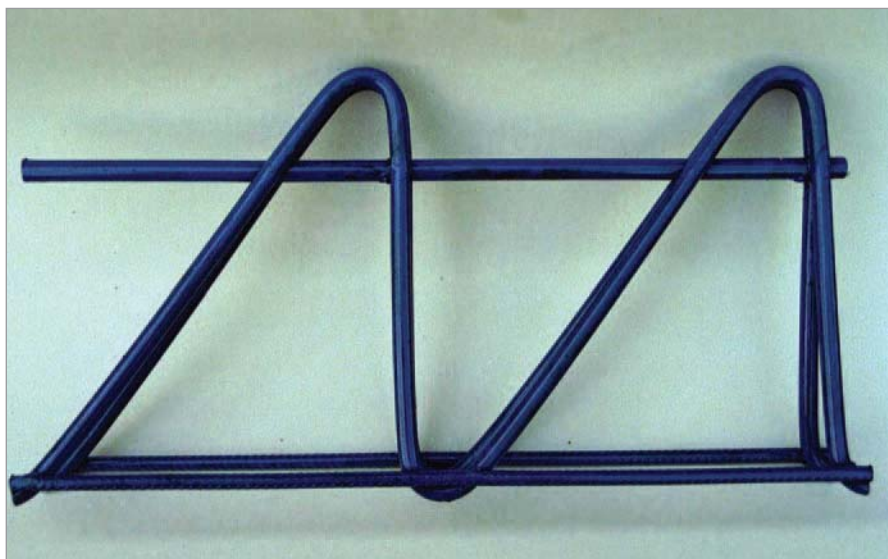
Filigran-Durchstanzbewehrung (FDB)
